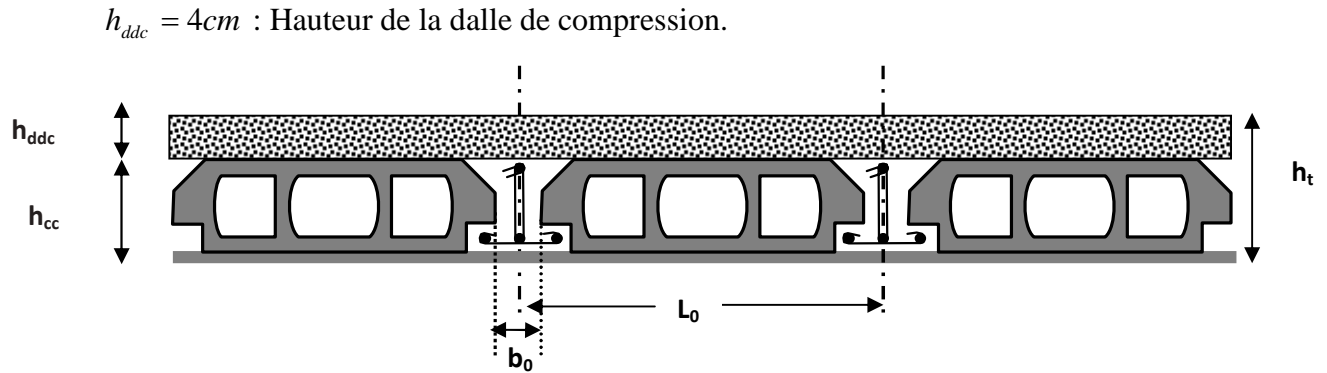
Coupe transversale sur un plancher à corps creux.
